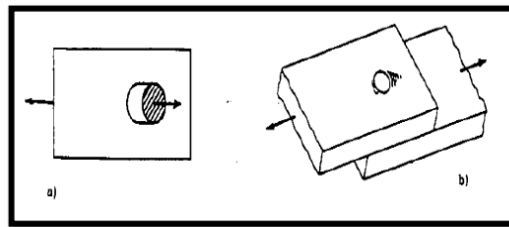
Falla por aplastamiento de las planchas. (Fratelli, 2003)
